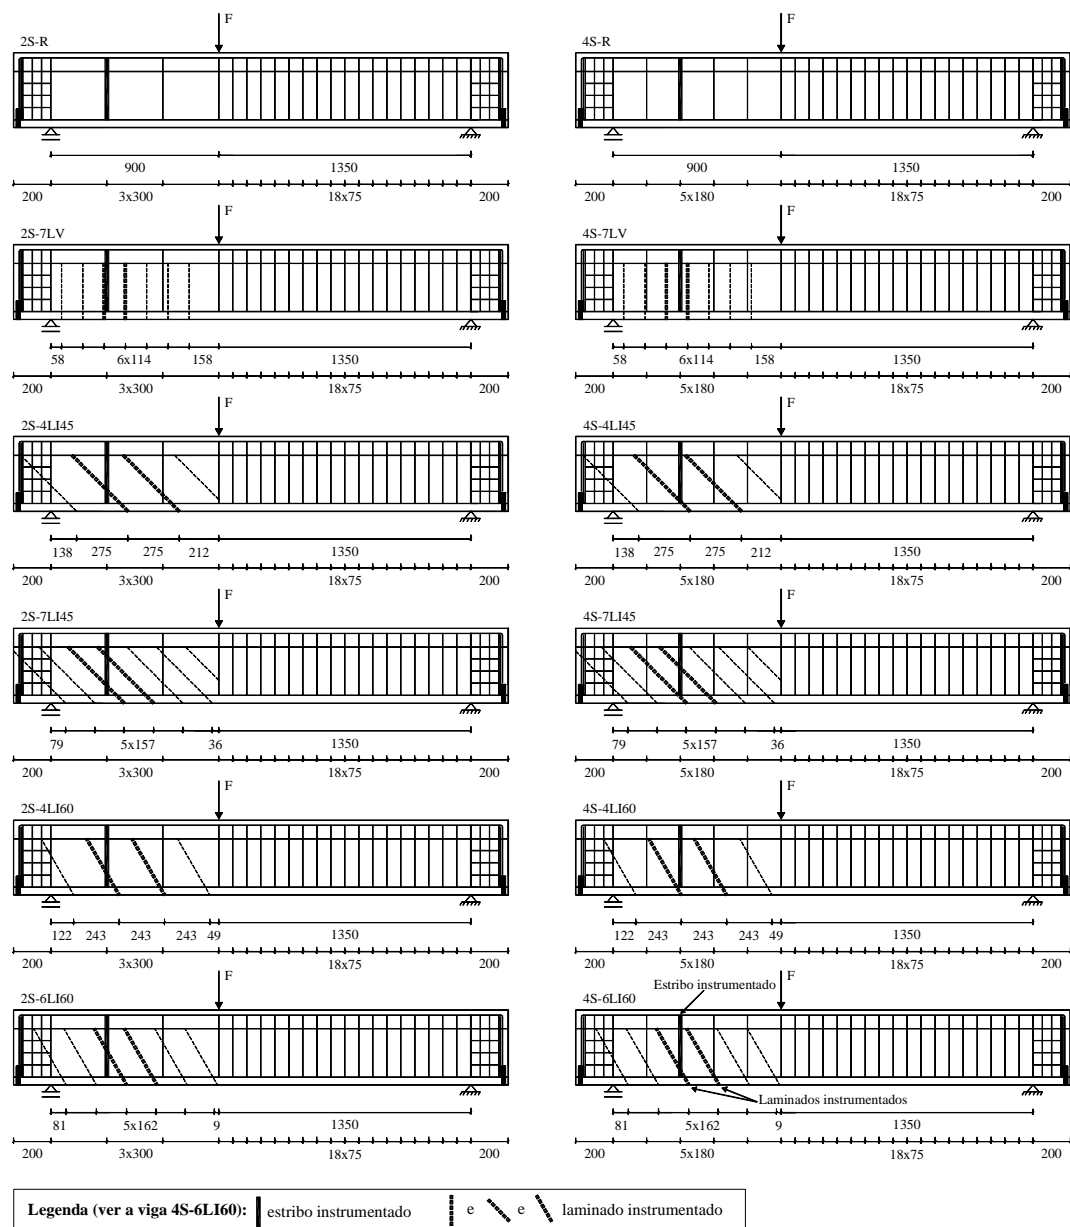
Localização dos estribos de aço (traço cheio) e dos laminados (tracejado) de CFRP (dimensões em mm).
